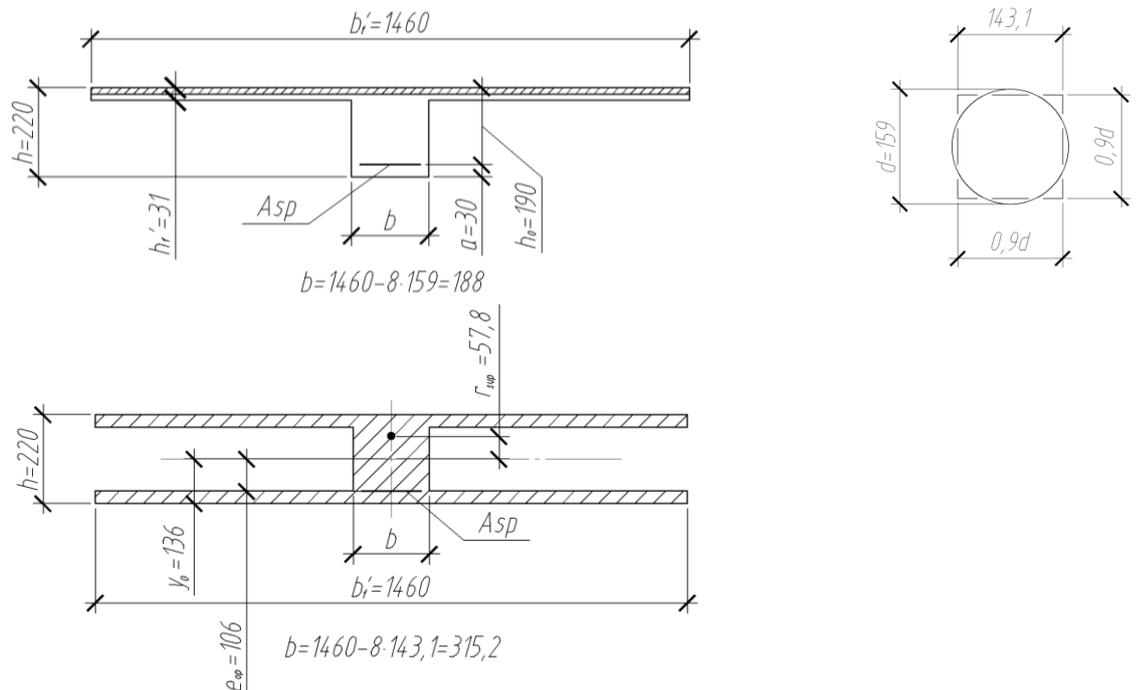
Приведенные сечения плиты с круглыми пустотами
